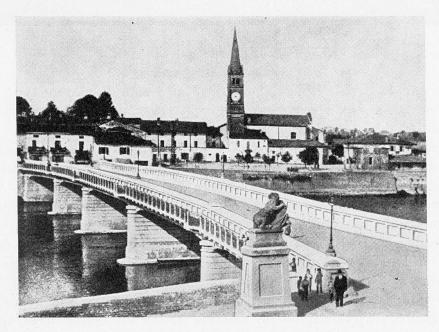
Pont sur l'Adda à Pizzighettone — Addabrücke bei Pizzighettone — Bridge over the Adda at Pizzighettone.
